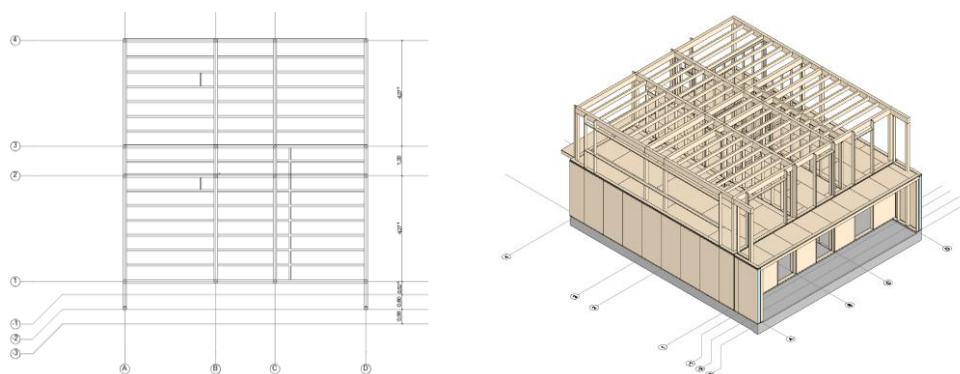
Planta e axonometria com uma solução alternativa de pavimento para o piso 2.
